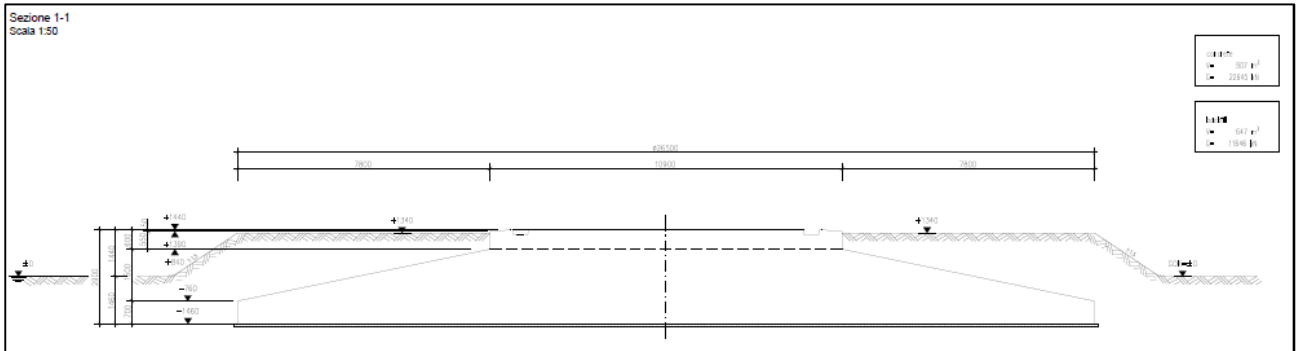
fondazione dell'aerogeneratore (da stralcio progettuale)
